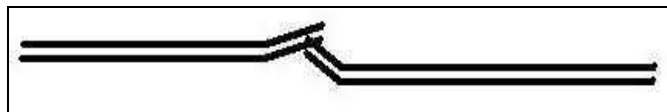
Vista en planta del trazado del túnel de Eupalinos.
